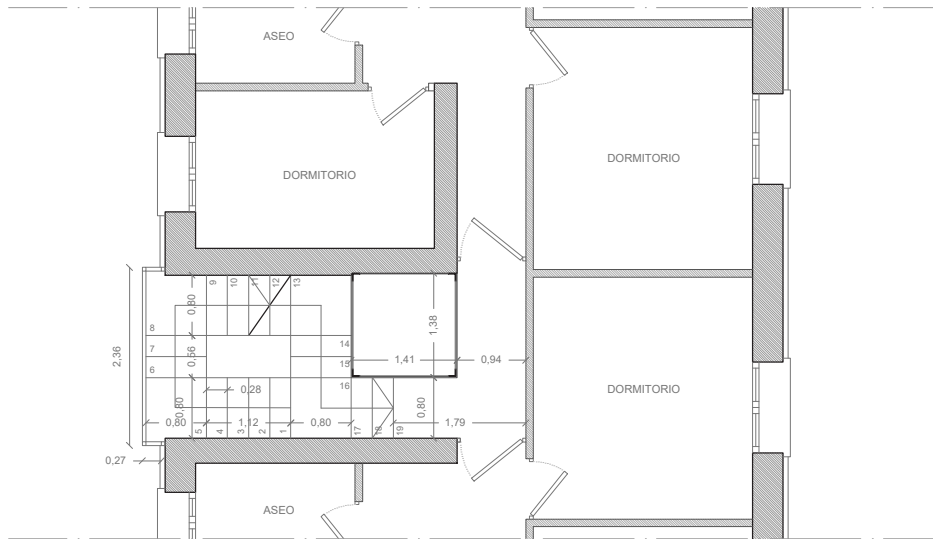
Zoom núcleo planta cuarta (e: 1/100).
